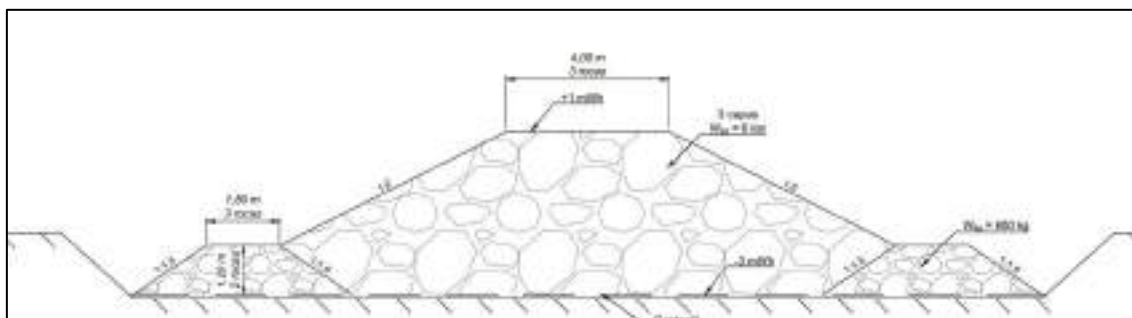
Sección tipo del tramo más expuesto del espigón norte de la Alternativa 2.
